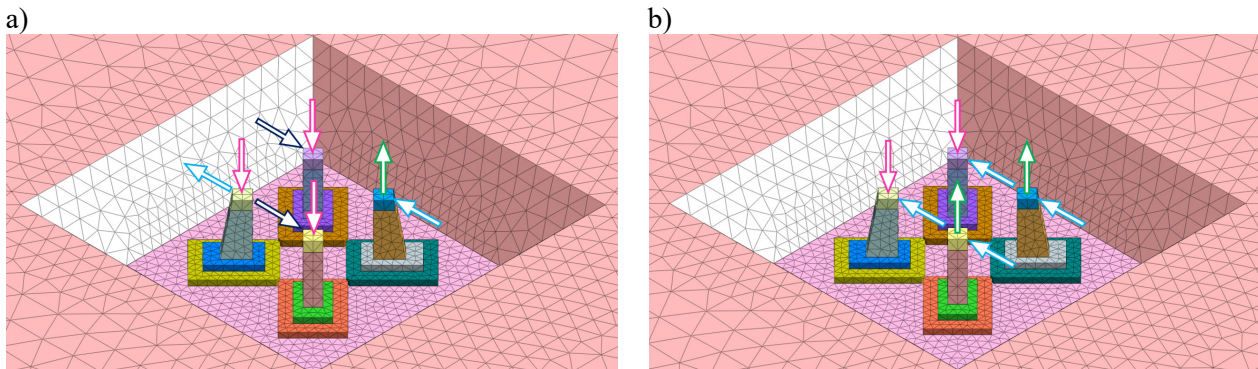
Схема прикладання навантаження до фундаментів: а) – вітрове навантаження прикладено на ребро вежі; б) – вітрове навантаження прикладено до грані вежі.
